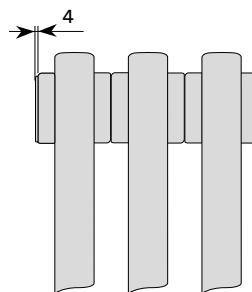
Längenzuschlag für geschweißte Deckel; der Längenzuschlag ist für beide Seiten des Heizkörpers zu berücksichtigen
